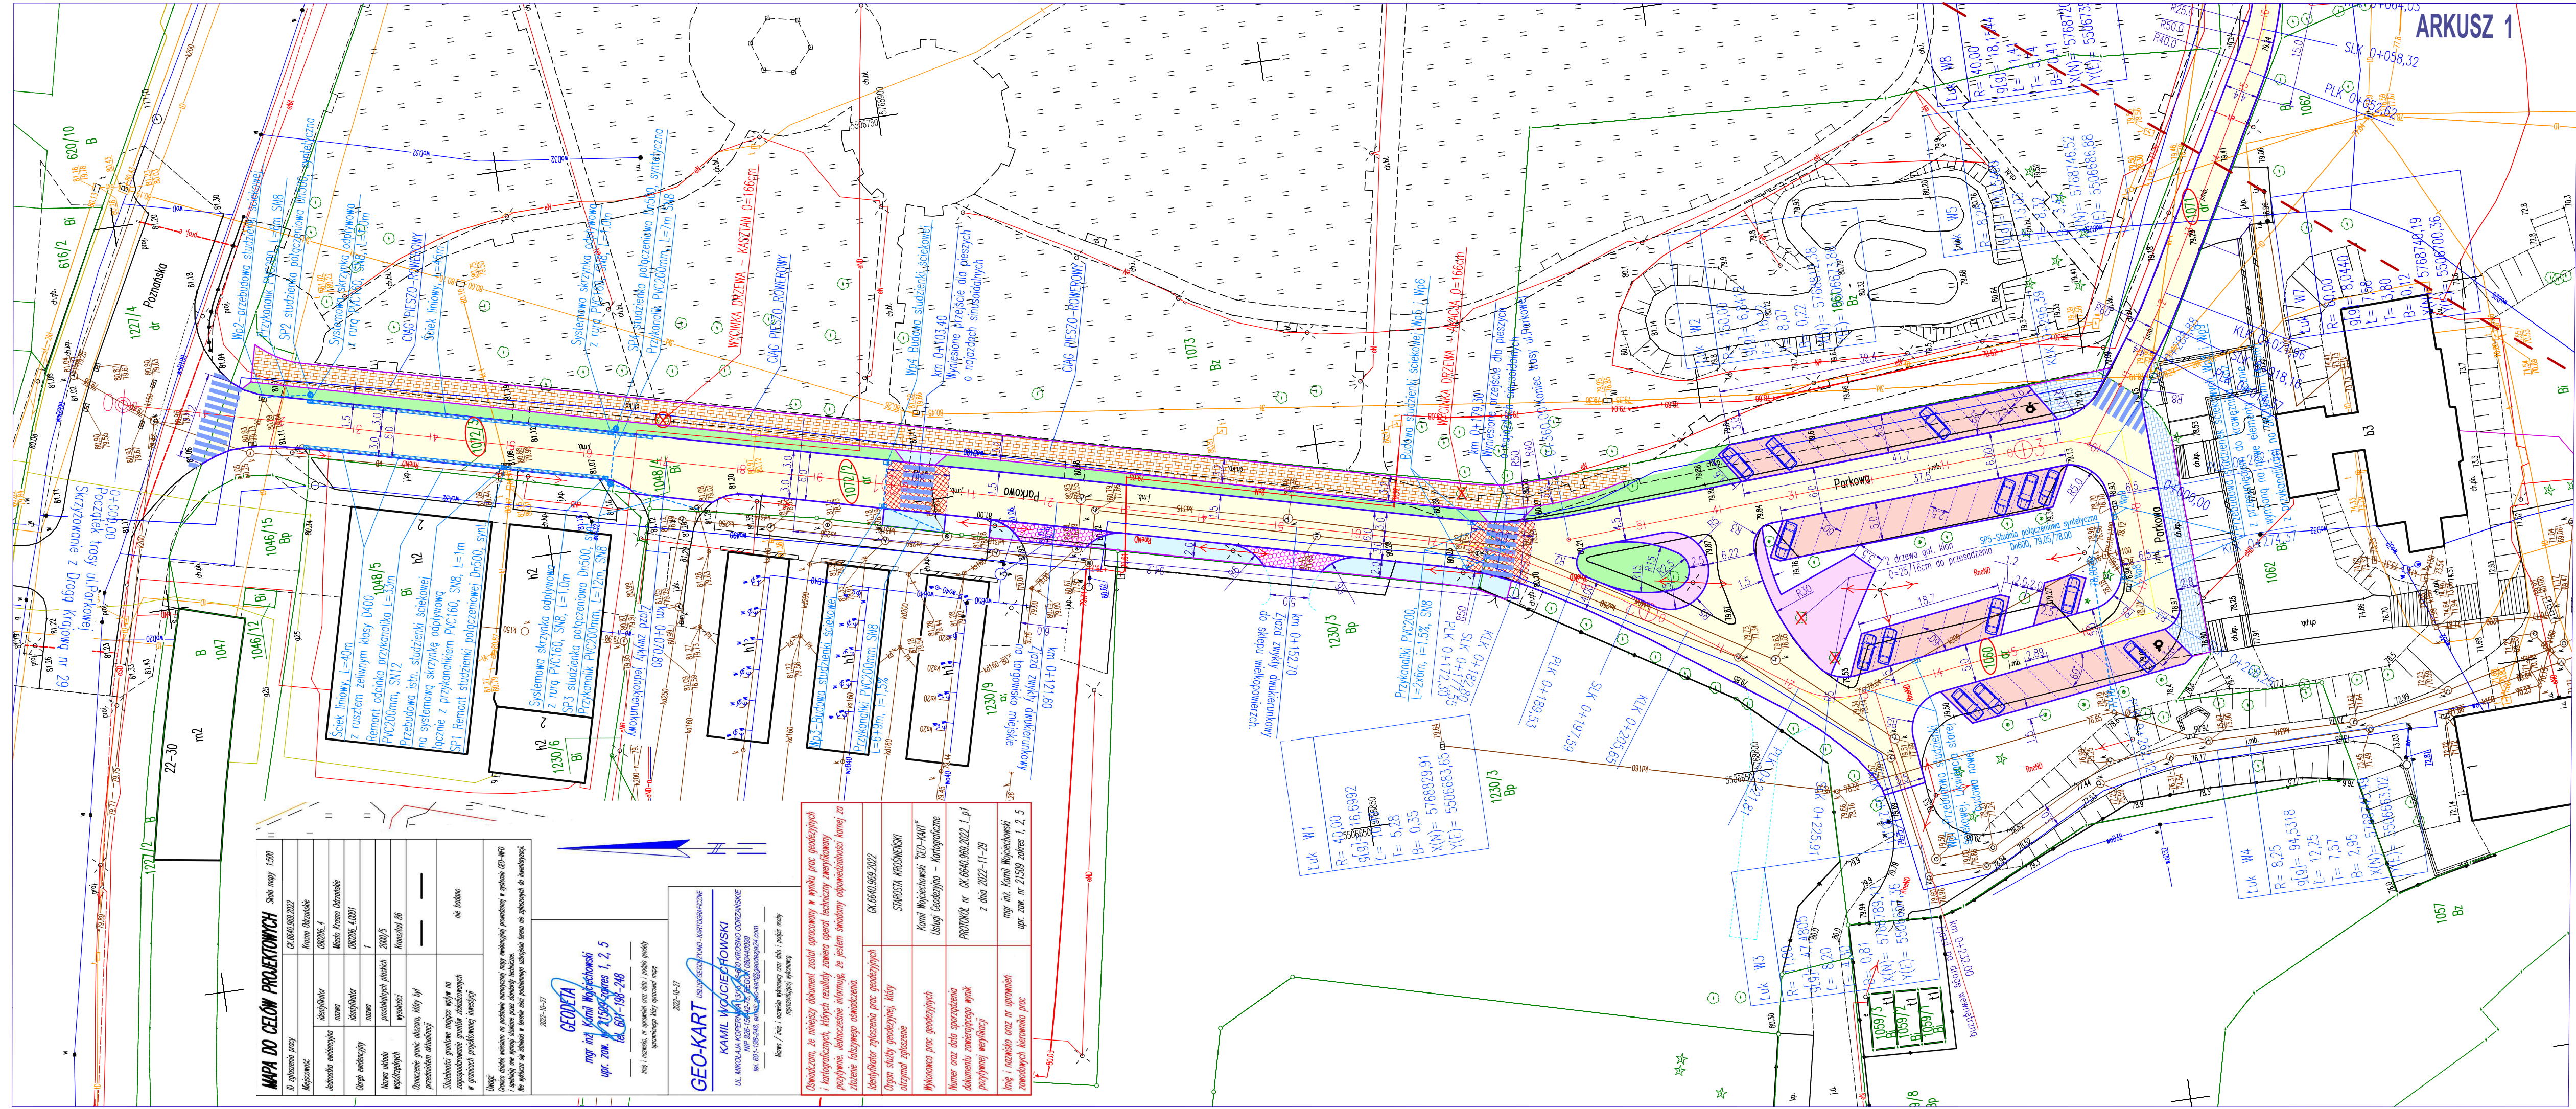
Plan Orientacyjny	str. 15
